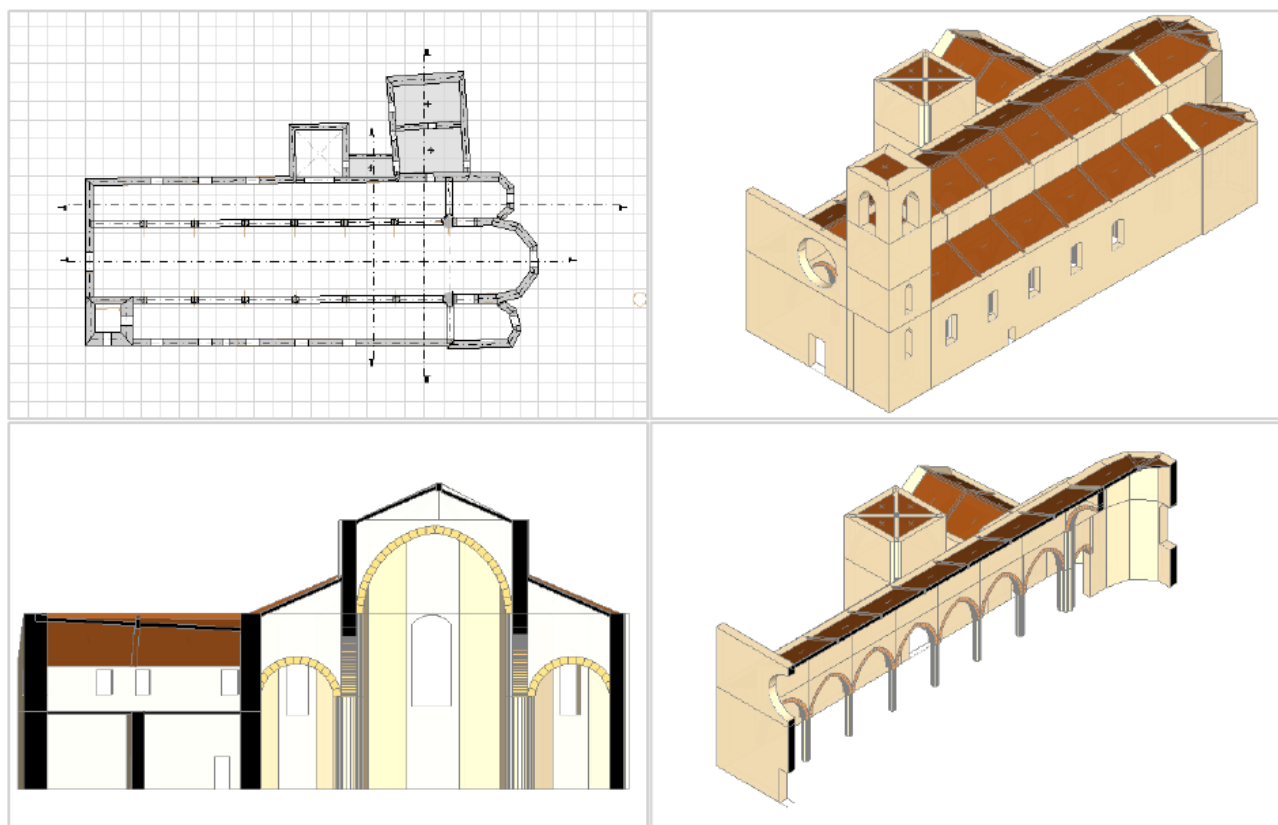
Chiesa San Silvestro: Piante, Assonometrie e Sezioni in PCM
